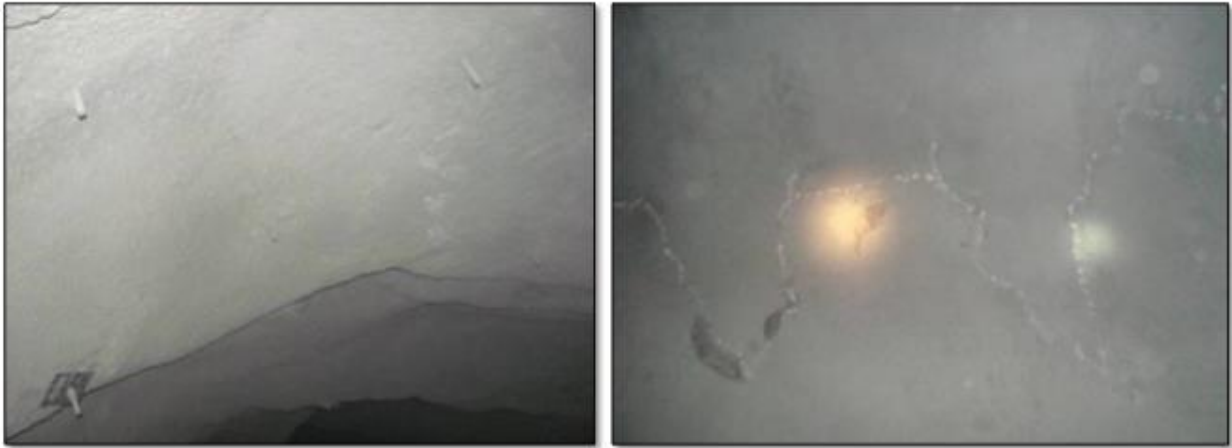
Daños en capa de shotcrete de galería debido a agrietamiento. (Baridelli and Villalobos, 2014)
